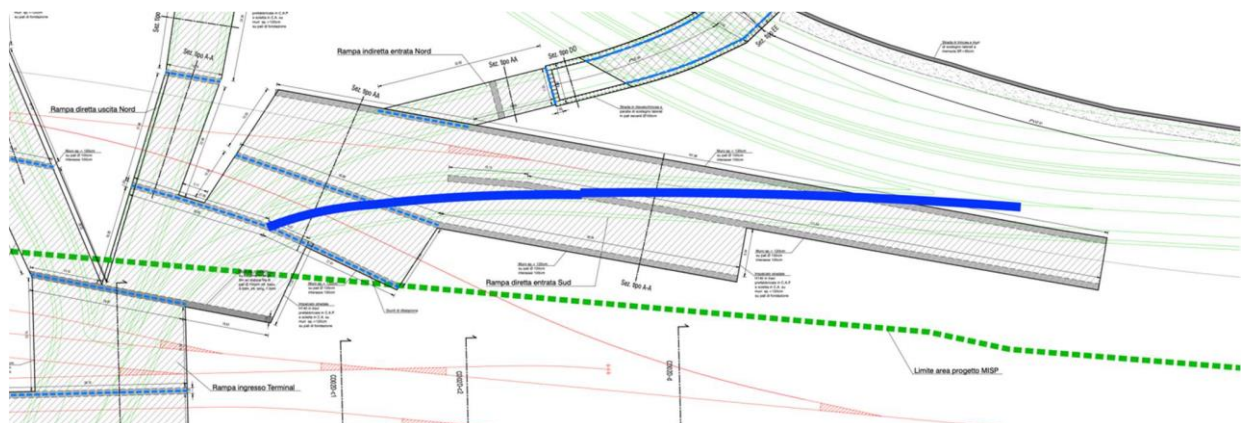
planimetria con evidenziata la rampa diretta uscita Sud
